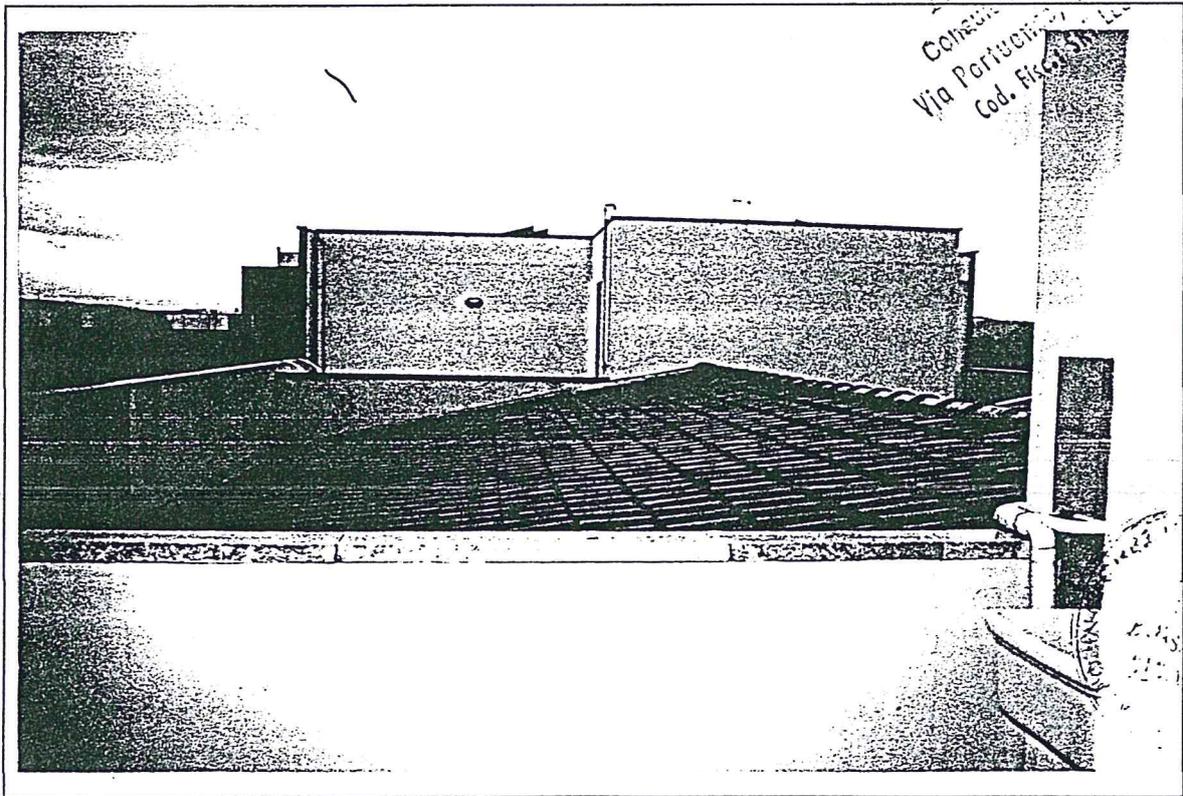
Vista della copertura dal terrazzo del sottotetto proprietà Sacco.
